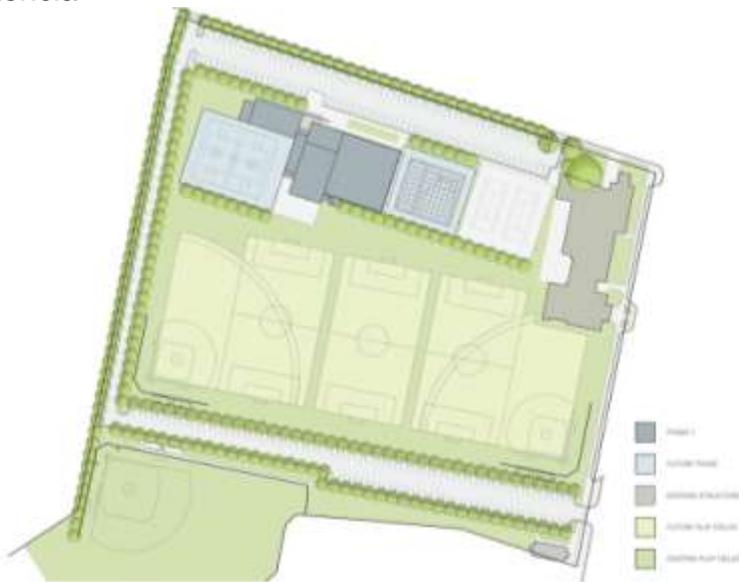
Planta de conjunto del East Oakland Sports Center.
